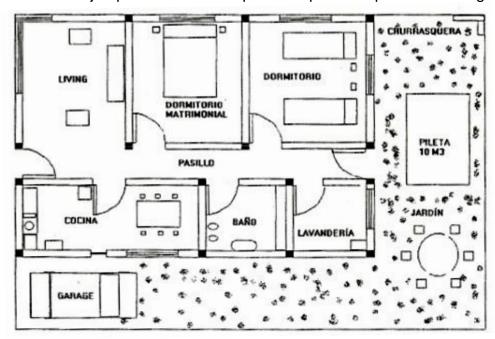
Plano de planta con detalle de aberturas y mobiliario
